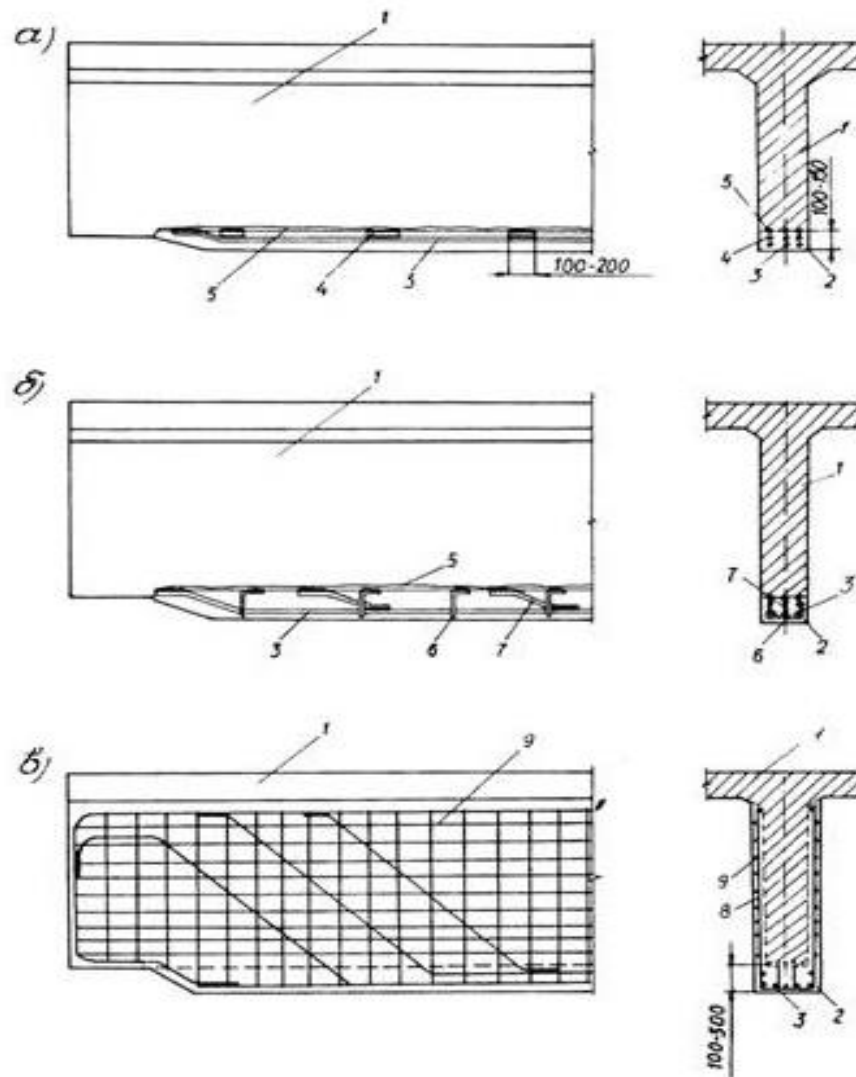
Традиційні способи посилення залізобетонних балок з об'єднанням додаткової та основної арматури (а – коротунами; б – похилими стрижнями та прямими хомутами; в – залізобетонною оболонкою): 1 – балка; 2 – додатковий шар бетону; 3 – додаткова арматура; 4 – коротуни; 5 – основна робоча арматура; 6 – короткий прямий хомут; 7 – похилий стрижень; 8 – хомут; 9 – протиусадкова арматура
